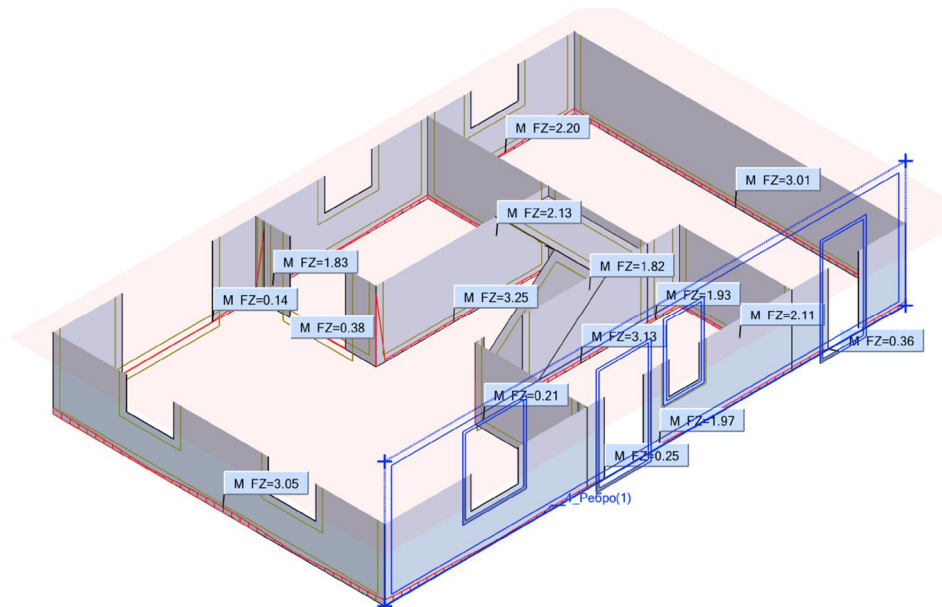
Расчетная линейная нагрузка на ленту фундамента по COMB 2, т/м
